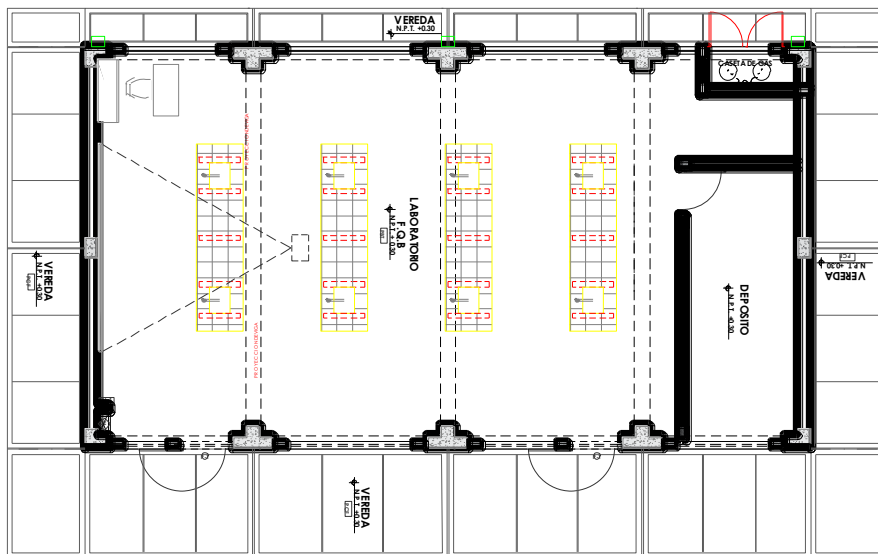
Planta arquitectura del Bloque VII (Primer piso).
